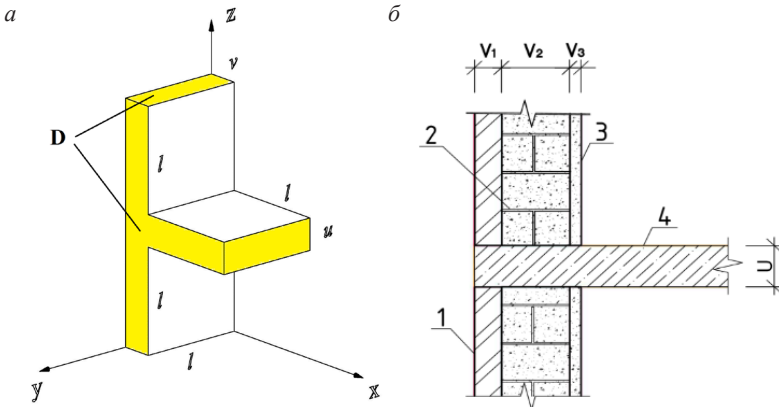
Базовый вариант узла сопряжения диска перекрытия со стеной:
